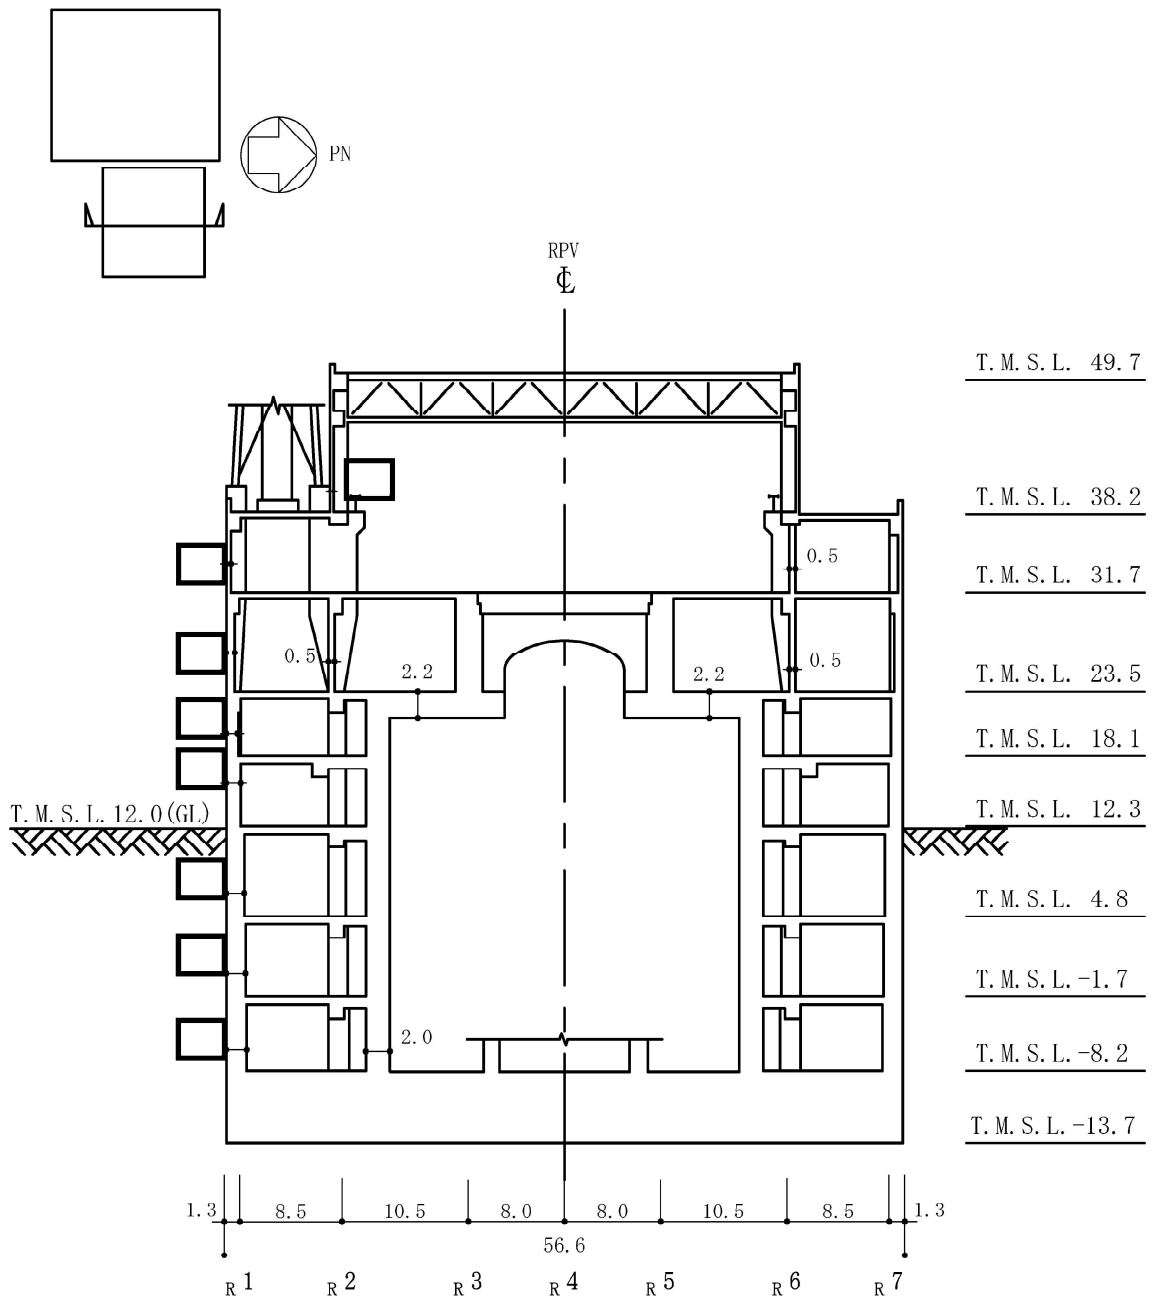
原子炉建屋の概略断面図 (NS方向) (1/2) (単位 : m)
